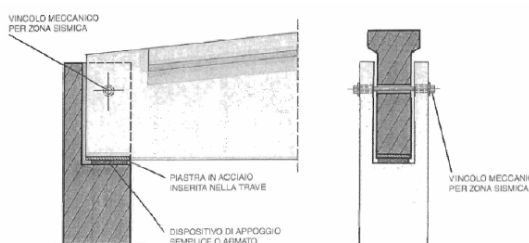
Collegamento trave-pilastro mediante barra orizzontale
